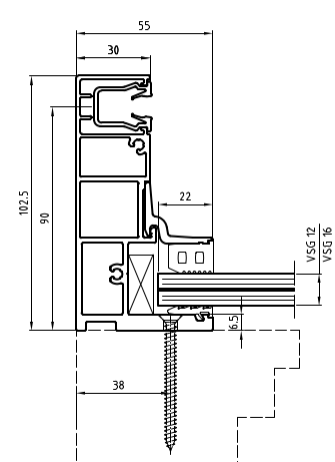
Führungsschiententypen Fa. WAREMA Renkhoff SE
